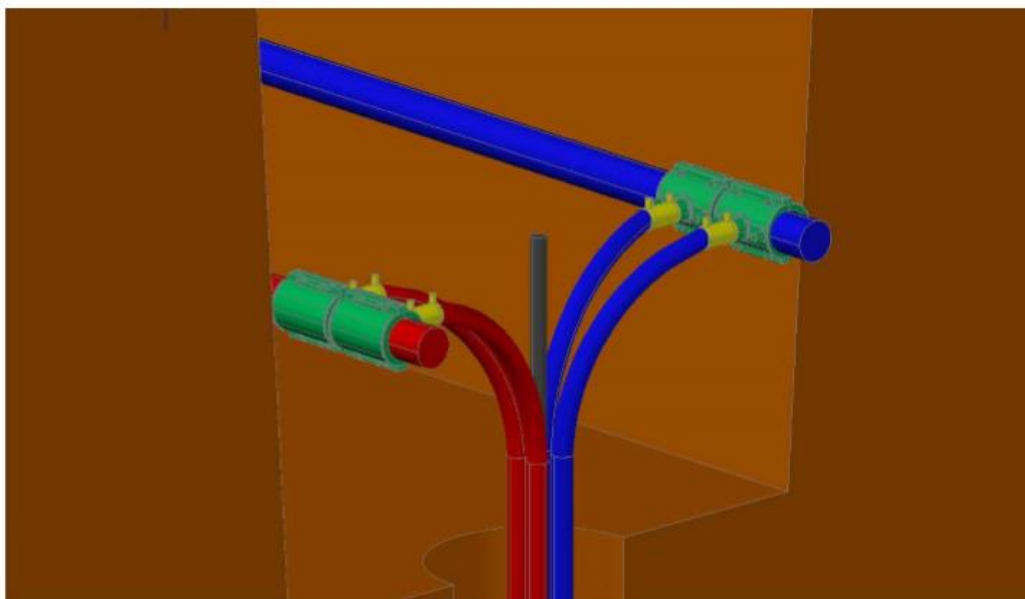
Dettaglio in sezione delle geosonde a "Doppia U"
